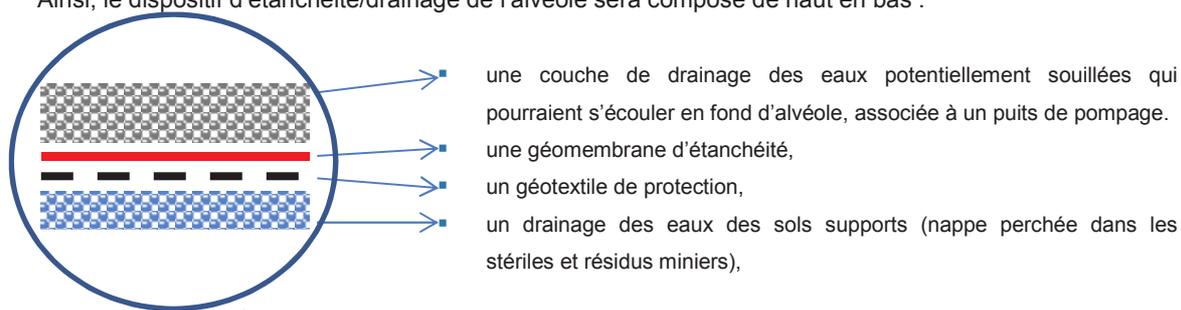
profil en long de l'alvéole et dispositif d'étanchéité/drainage de l'alvéole
